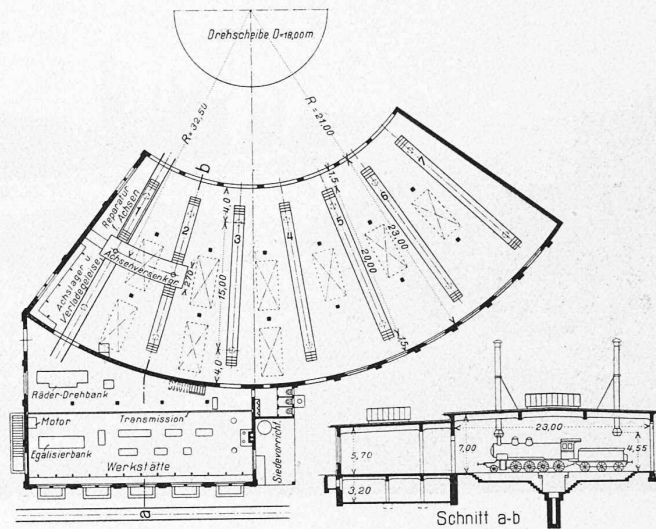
Grundriss und Schnitt von Depot und Werkstätte. Masstab 1 : 800.
